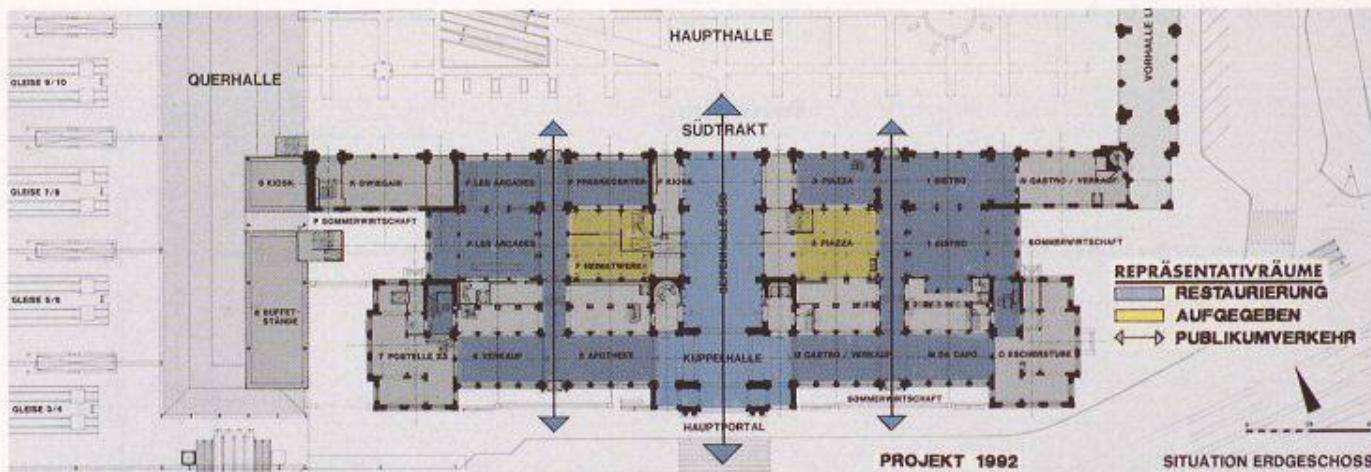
Gesamtplan 1992 (Grundriss Erdgeschoss). Wiederherstellung der ursprünglichen Gebäudestruktur
